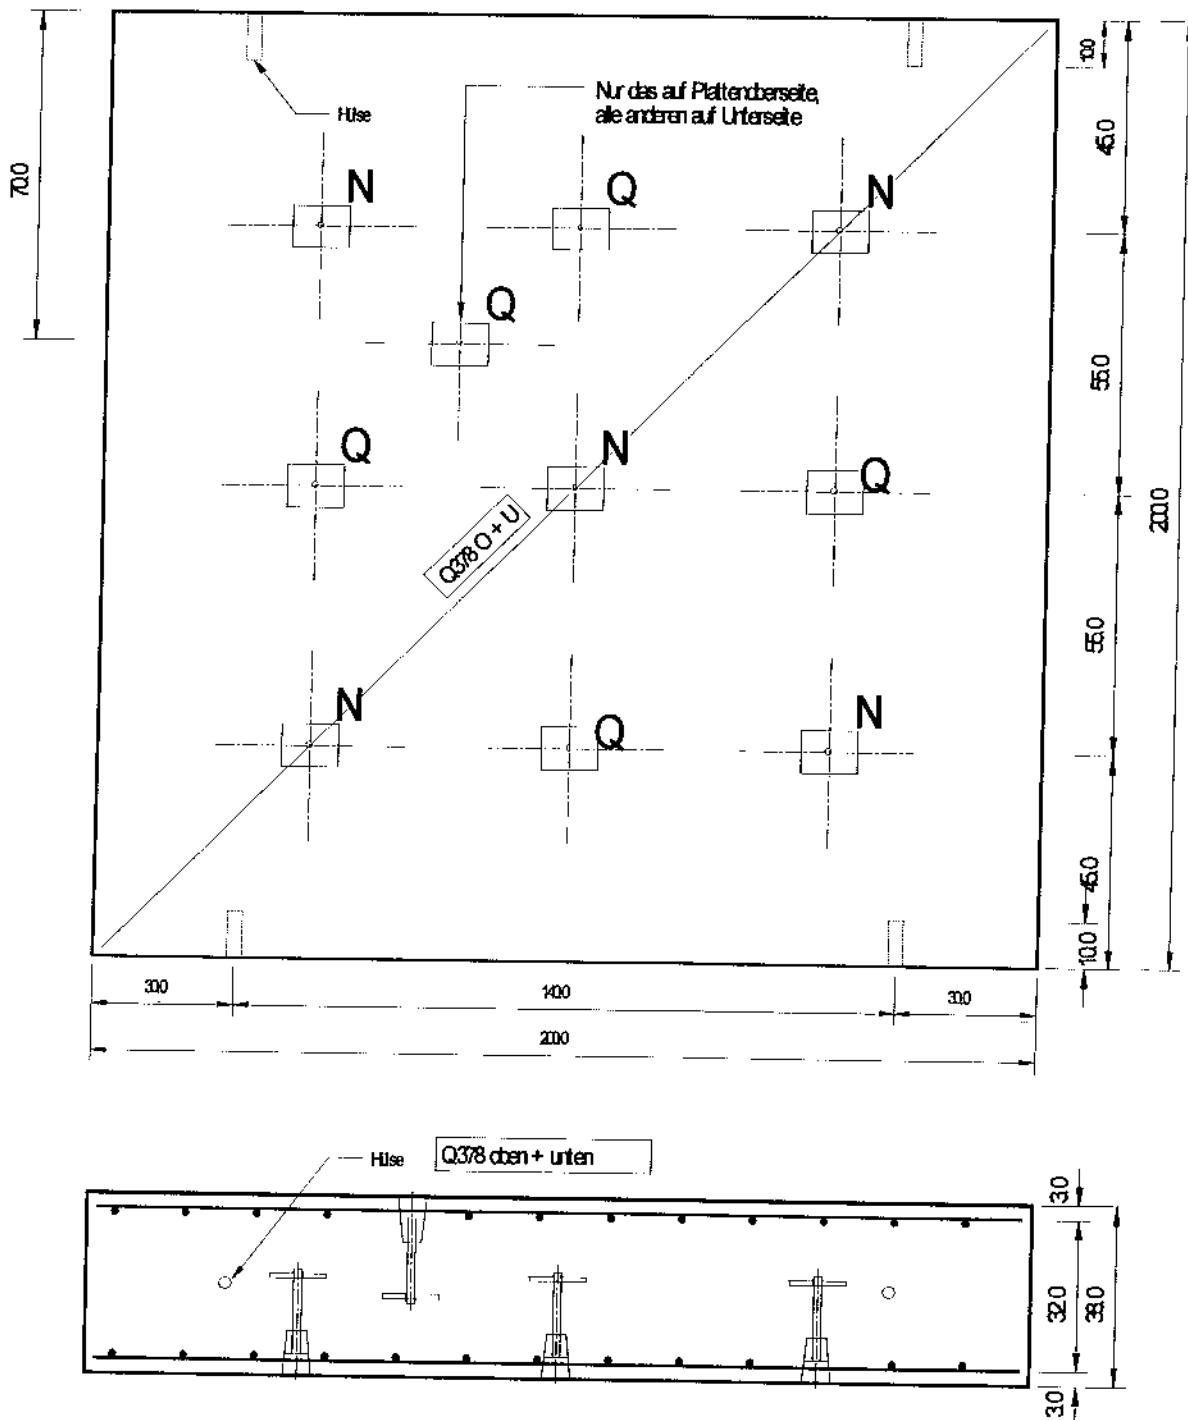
Betonplatte mit Lage der einbetonierten Sperranker
